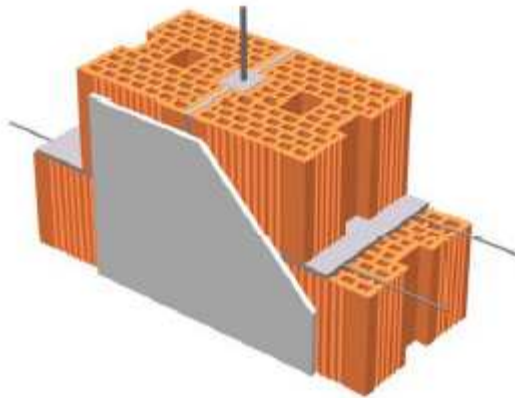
Posizionamento delle barre di armatura verticali e orizzontali
